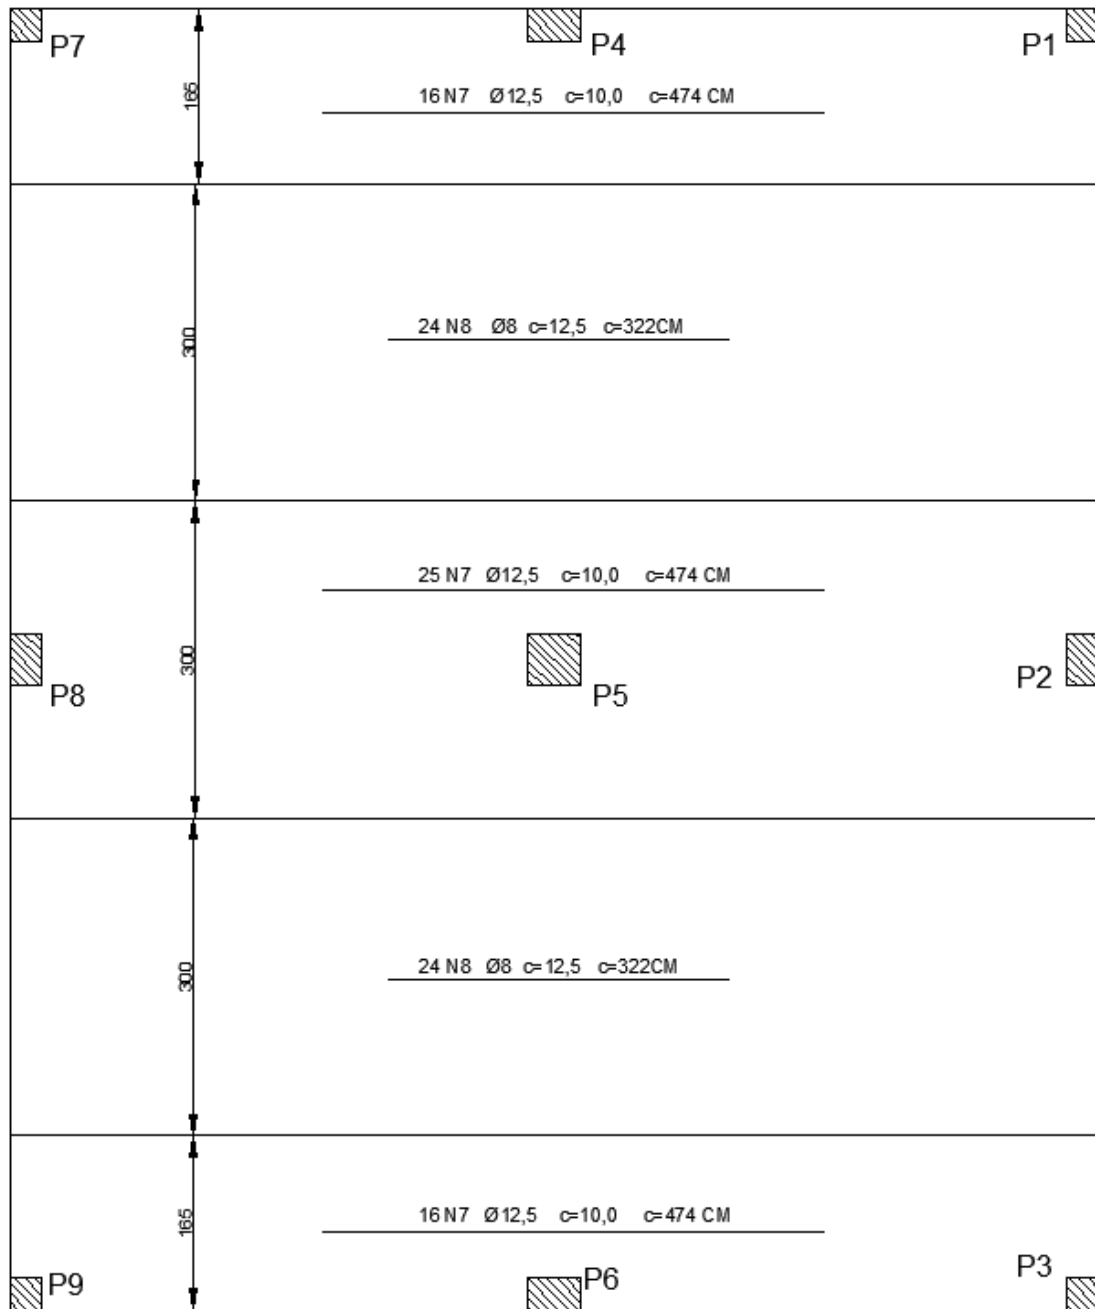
Armaduras superiores na direção Y pela NBR 6118/2014
